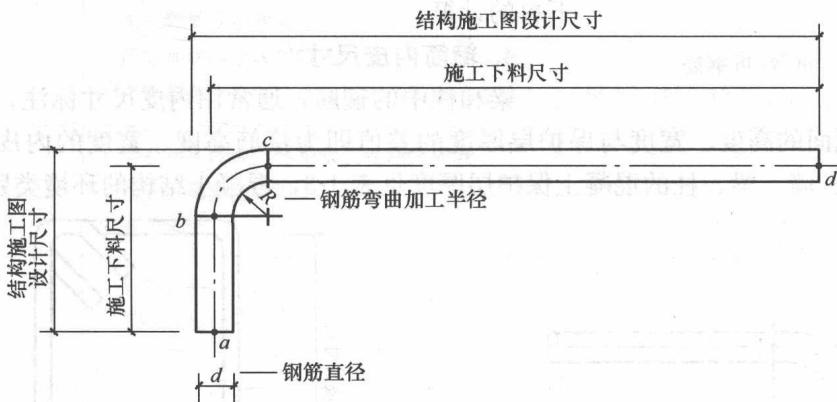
结构施工图上所示受力钢筋的尺寸界限
